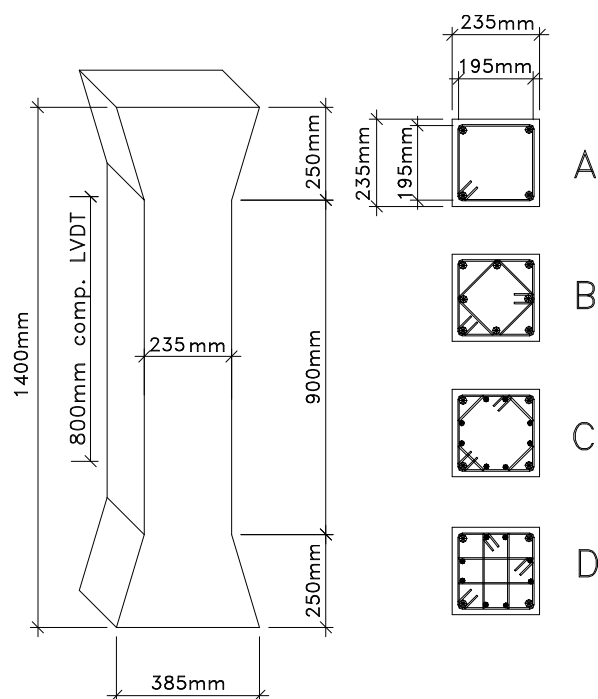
Pilares ensaiados por [CUSSON & PAULTRE(1994)]
